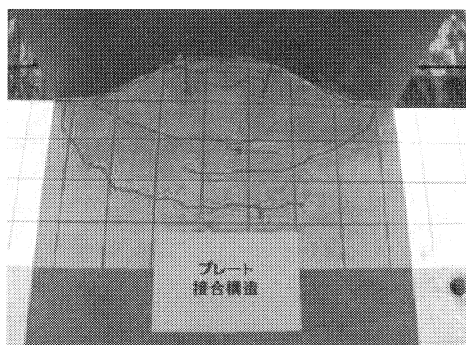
ひび割れ状況 (P 1 供試体)
